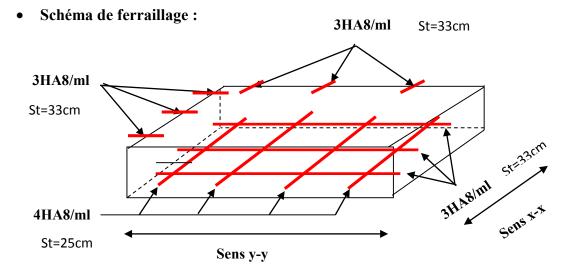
Schéma de ferraillage de la dalle pleine du local machine.
